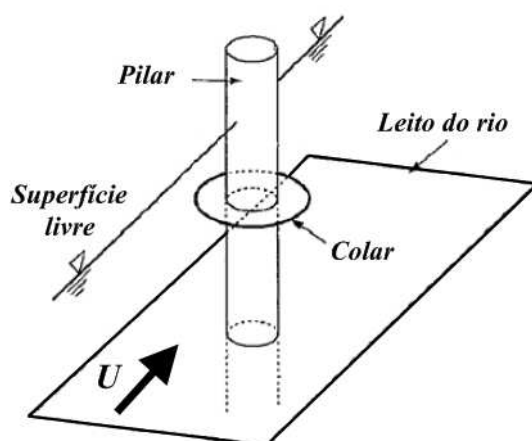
Esquema de um pilar com um colar colocado acima do leito do rio (adaptado de ALABI 2006).
